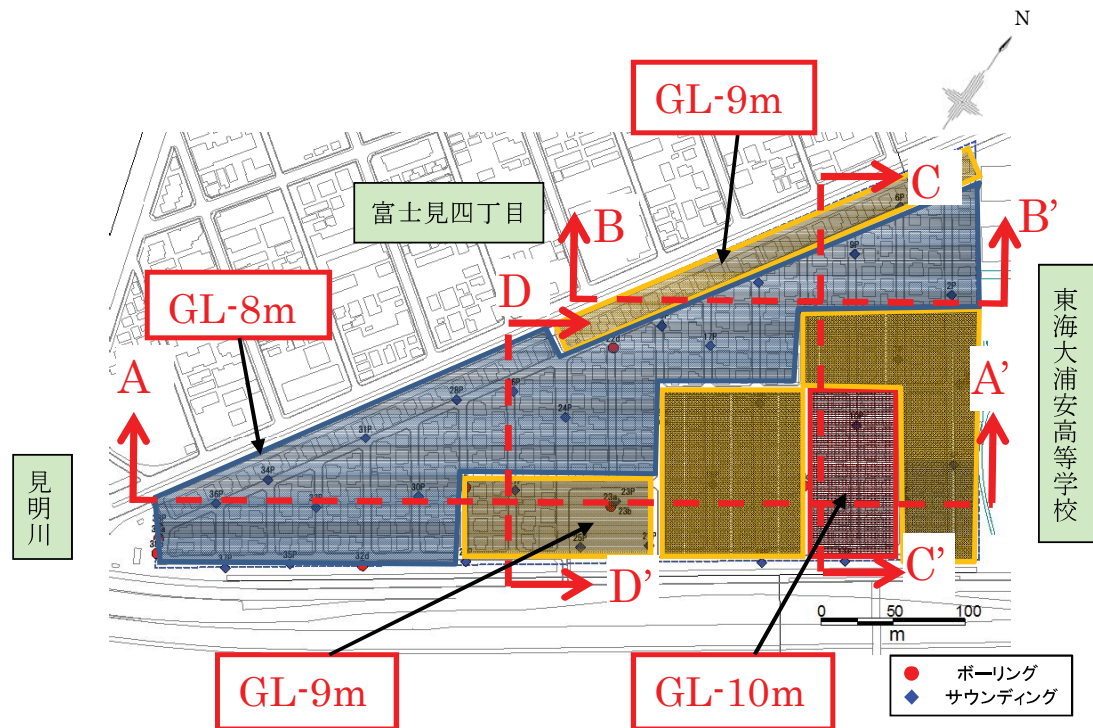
改良体下端深度の平面分布図（東野三丁目）
